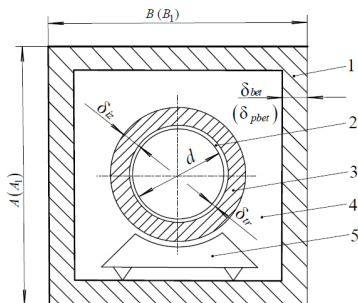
Схема подземной прокладки трубы с наружной изоляцией в бетонном коробе (в скобках приведены обозначения для пенобетонного короба): 1 – прямоугольный короб; 2 – металлическая стенка трубы; 3 – слой тепловой изоляции на поверхности трубы; 4 – слой воздуха; 5 – кронштейн крепления трубы в коробе
